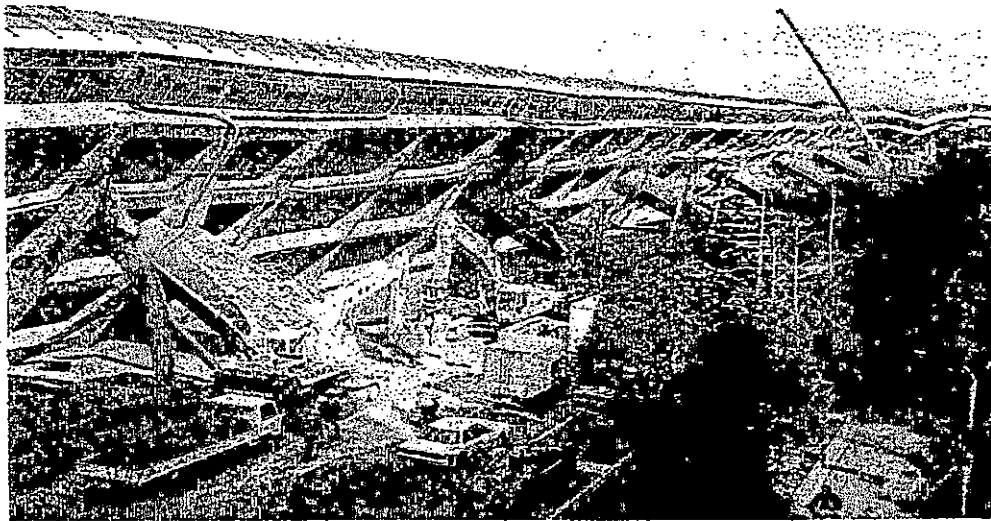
FALLAS A FLEXIÓN EN LA BASE DE LAS COLUMNAS DE LA VÍA EXPRESS HANSHIN, DEBIDO A LA PREMÁTURA TERMINACIÓN DEL REFUERZO LONGITUDINAL E INADECUADO CONFINAMIENTO; TERREMOTO DE KOBE EN JAPÓN 1995.
